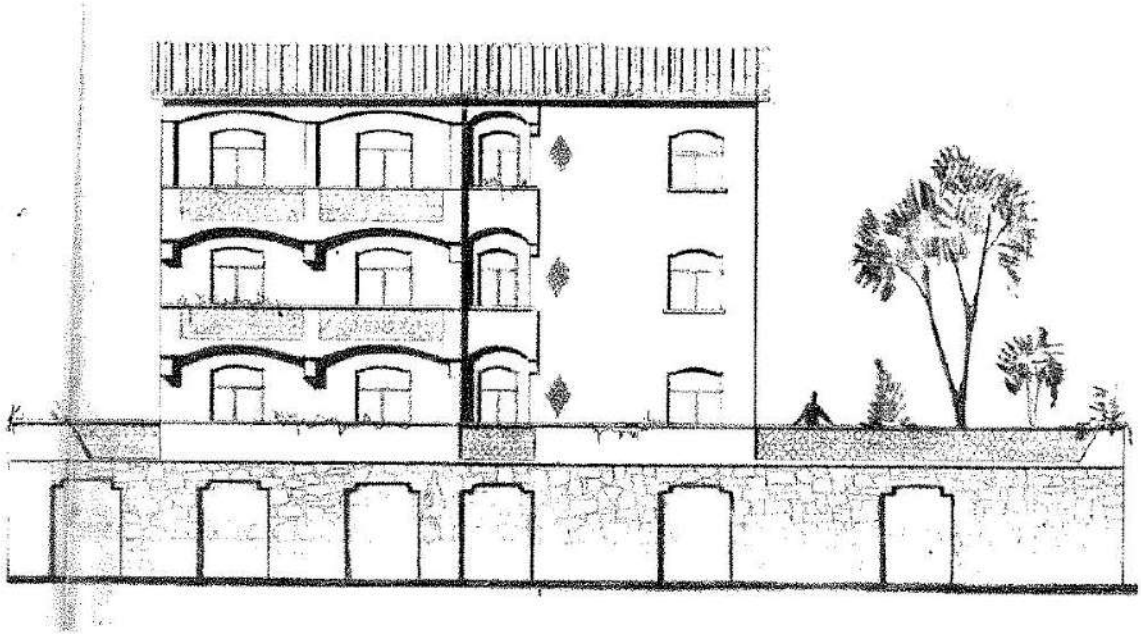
Progetto approvato dalla CE del 29/12/1961. Prospetto palazzina A
